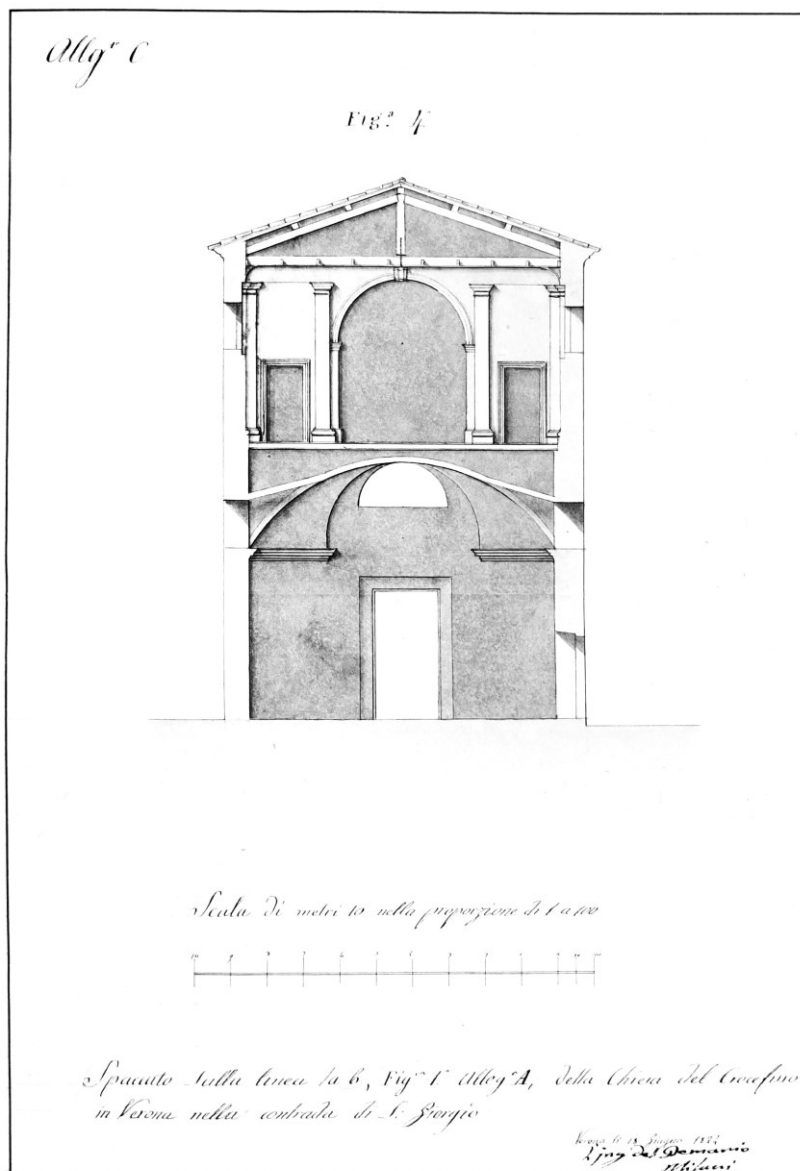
Sezione trasversale della chiesa e oratorio del Crocifisso rilevata nel 1824 [Archivio di Stato di Verona, Delegazione provinciale, b. 786].
